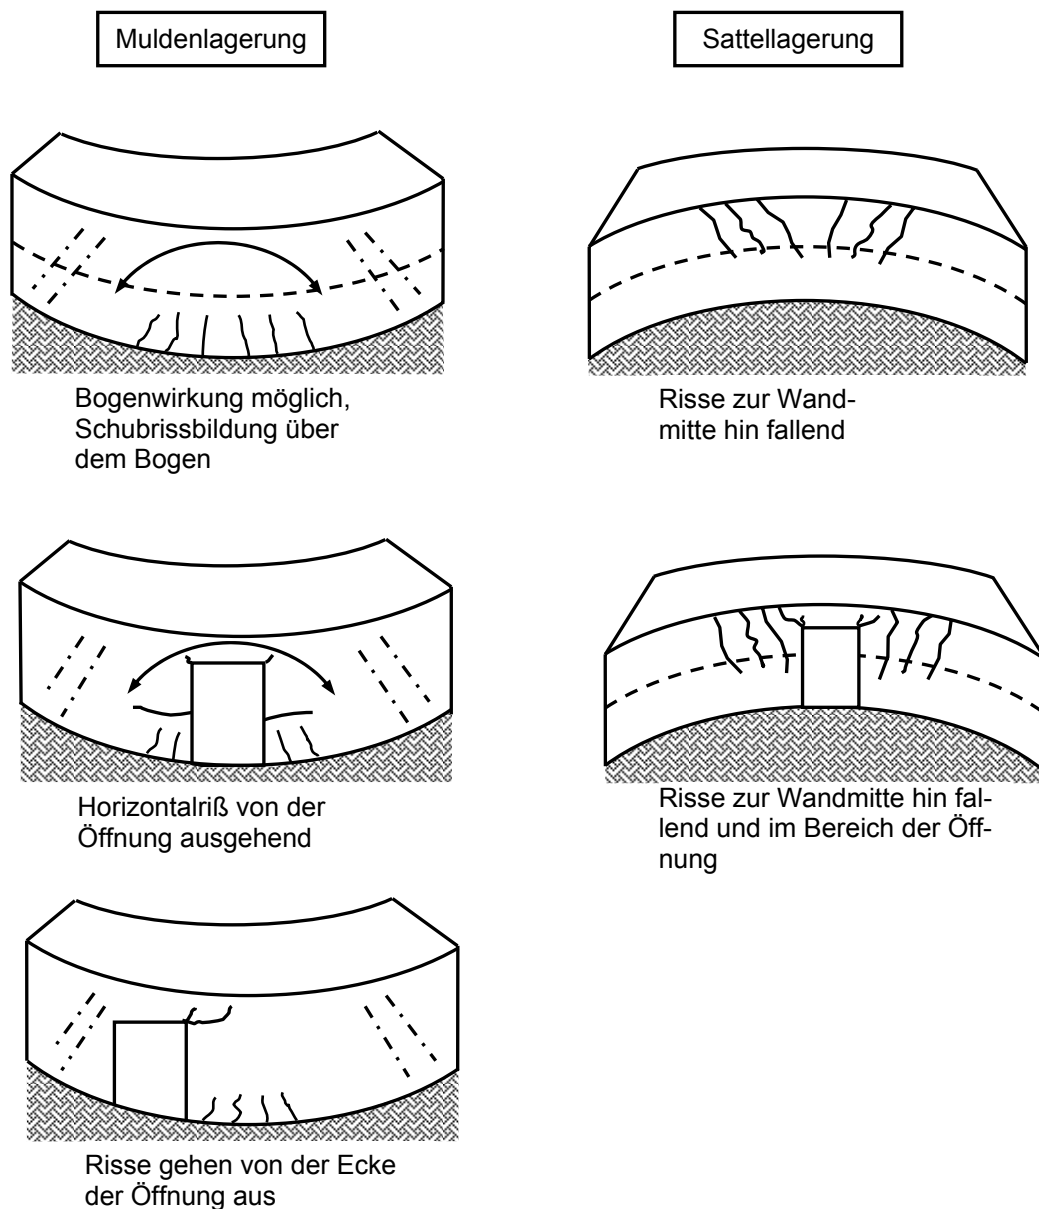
Rissbildung bei Mulden- und Sattellagerung von Gebäuden oder Bauteilen aus Mauerwerk
